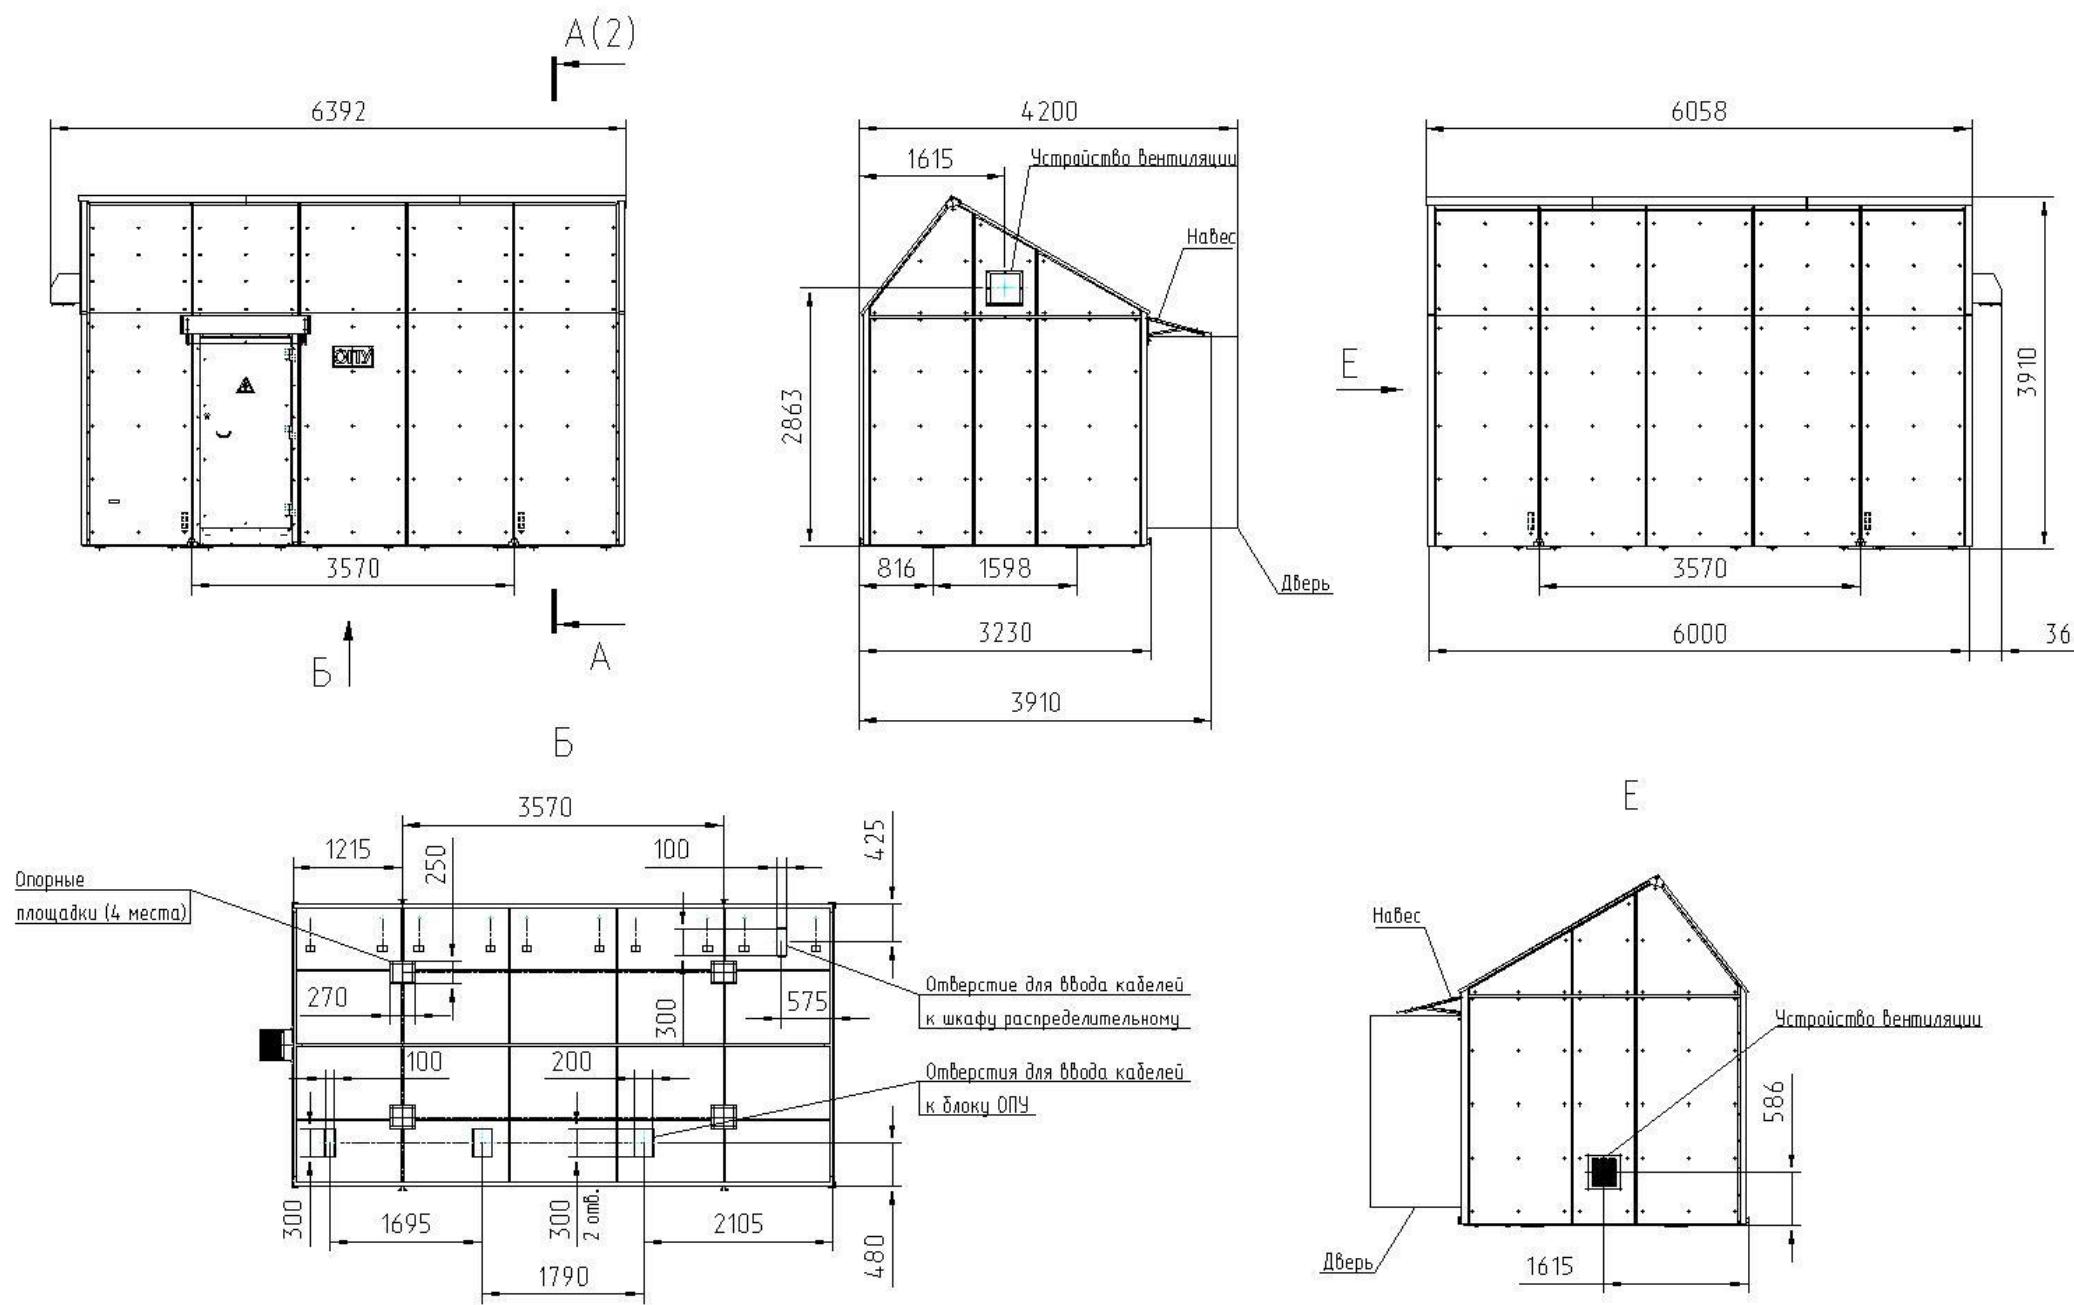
Габаритный чертеж модуля ОПУ типоразмером 6 м
